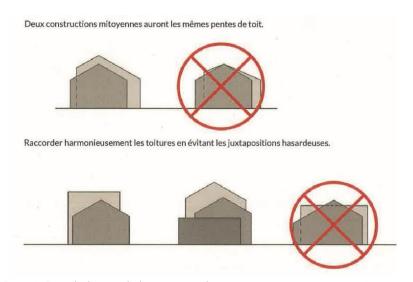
Exemple de raccords de toiture entre deux constructions mitoyennes autorisés ou non
